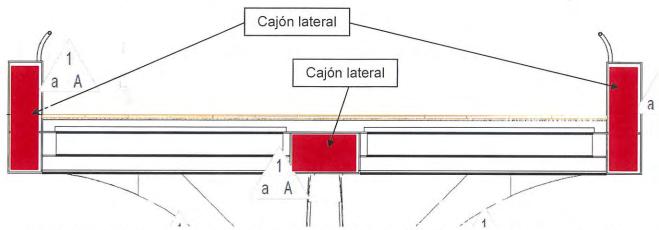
Vista de corte transversal de Calzada Peatonal Chivatito, resaltando en rojo las vigas (cajones) longitudinales.
